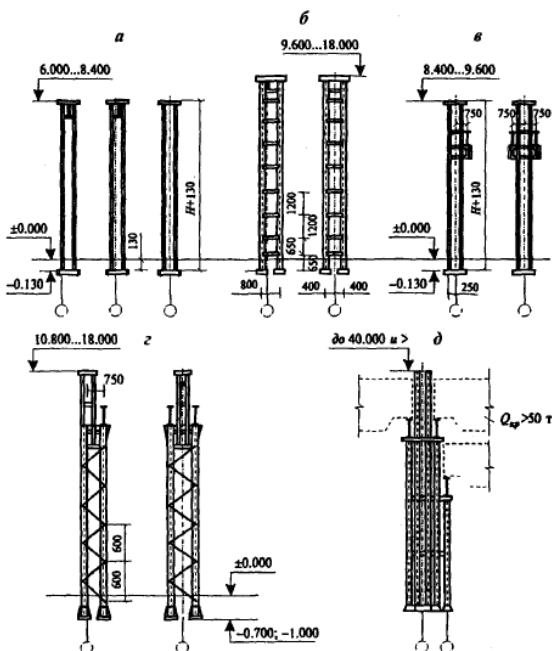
Основные типы стальных колонн: а — сплошного постоянного сечения для зданий без мостовых кранов; б — то же двухветвевое сечения; в — сплошного сечения для зданий, оборудованных мостовыми кранами; г — то же двухветвевое переменного сечения; д — то же, отдельного типа переменного сечения.
